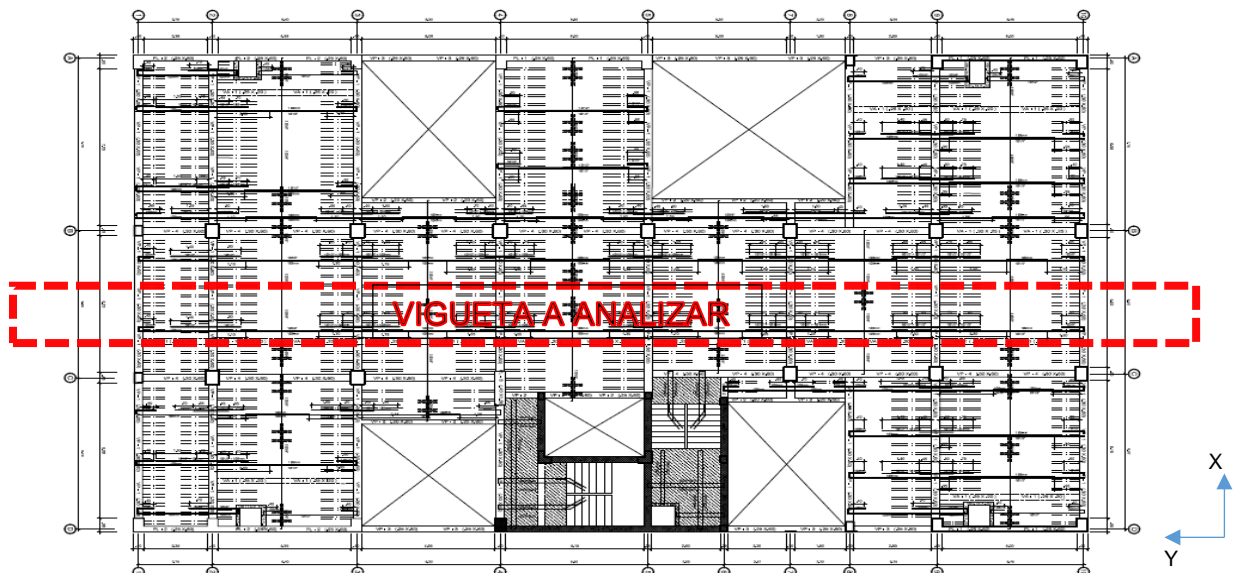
Vigueta a analizar para el metrado de cargas
